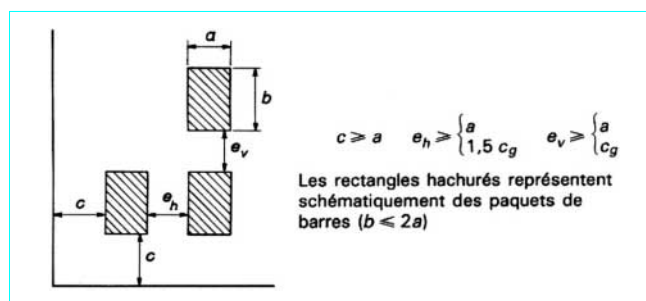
Enrobages et distances minimales entre barres ou paquets de barres
